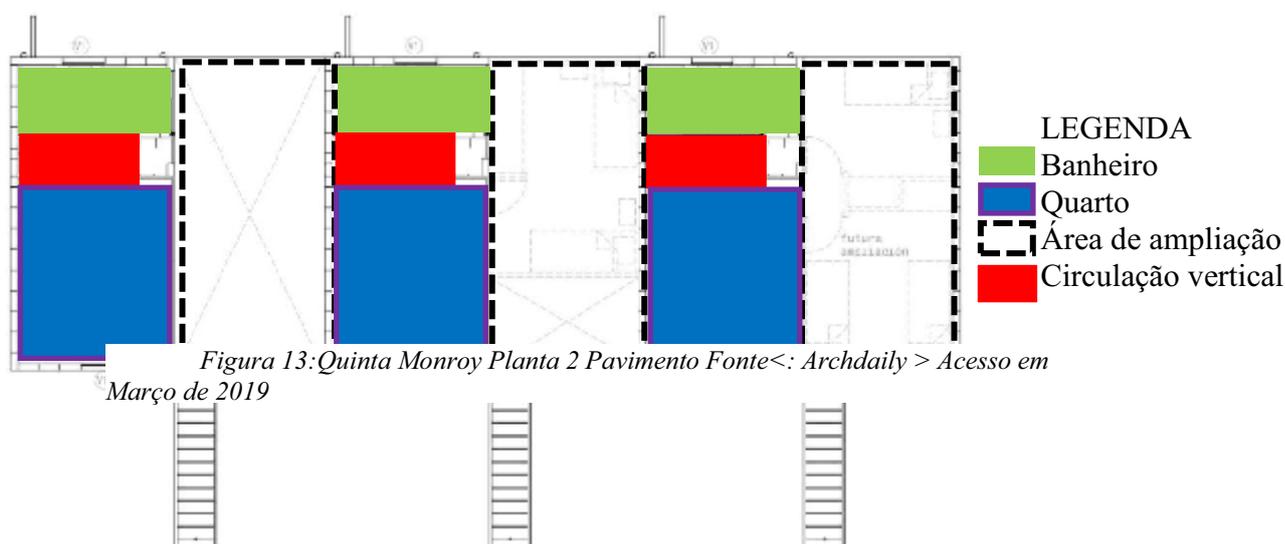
Quinta Monroy Planta 2 Pavimento Fonte<: Archdaily > Acesso em Março de 2019
